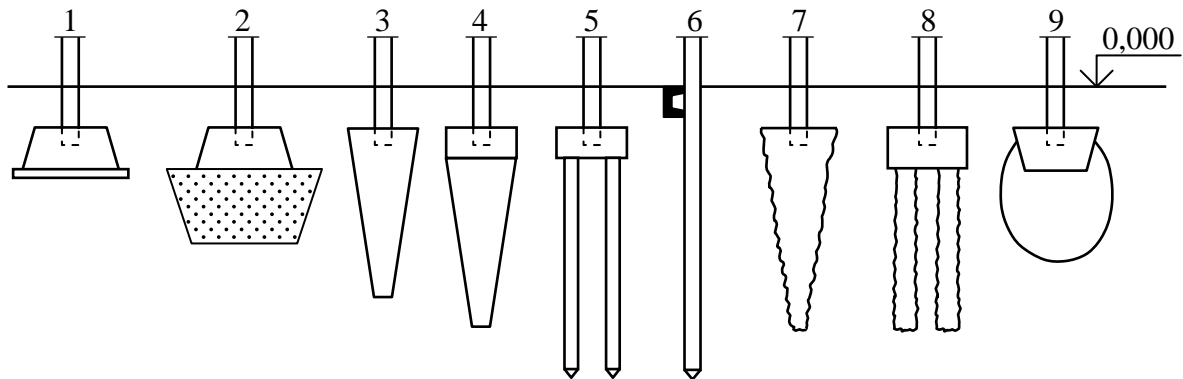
Фундаменти під колони каркасів і естакад:
